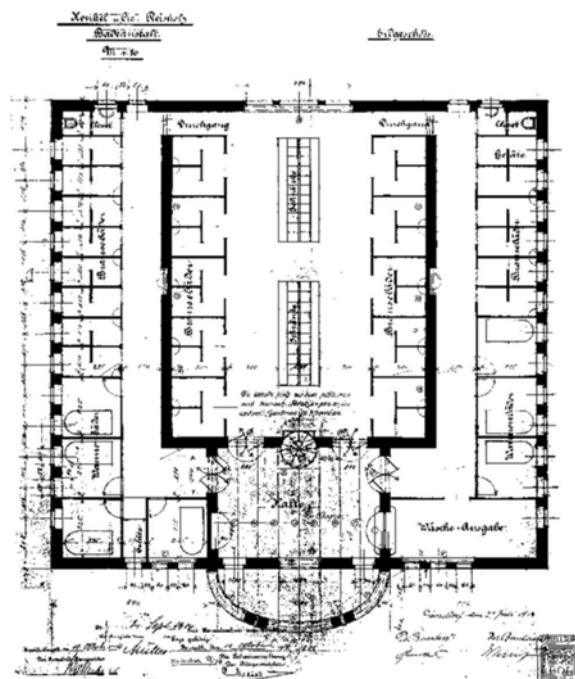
HENKEL-Badehaus, Grundrisszeichnung von 1914 – Architekt: Walter Furthmann
